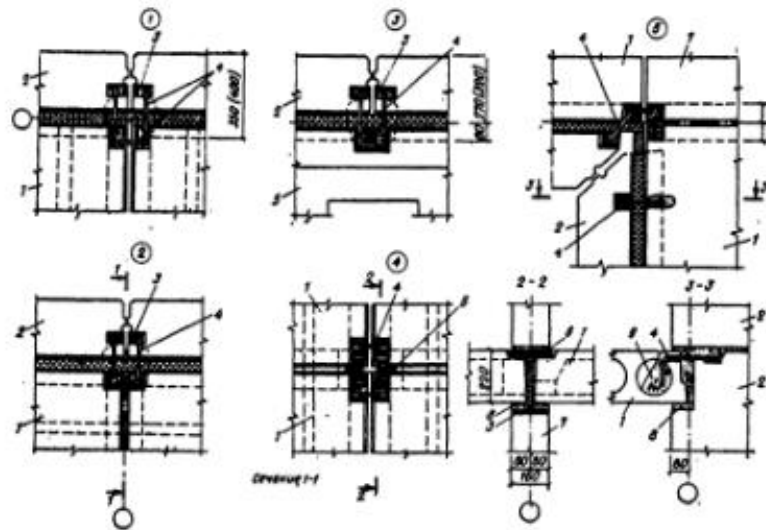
Узлы 1—5 сопряжения панелей перекрытия: 1 — панель перекрытия; 2 — панель наружной стены; 3 — закладная деталь; 4 — арматурный соединительный стержень; 5 — сантехническая панель перекрытия; 6 — соединительная стальная пластина; 7 — панель внутренней стены; 8 — цементный раствор; 9 — бетон замоноличивания
